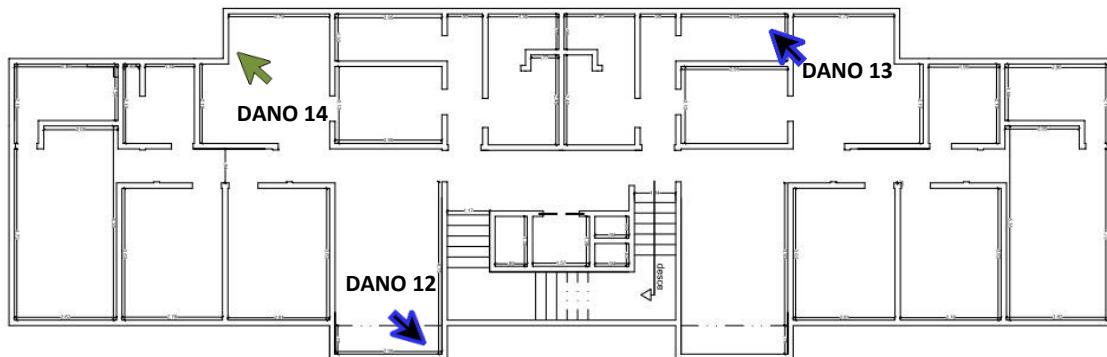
Planta Baixa (croqui) – Pavimento do 5º andar – Bloco B – Cond. Armando Lôbo.
